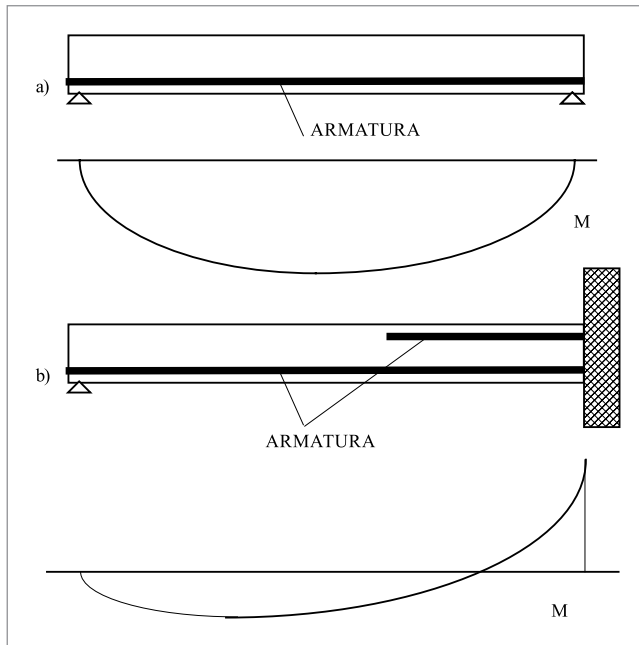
Disposizione teorica delle armature in: a) trave appoggiata, b) trave con appoggio e incastro
